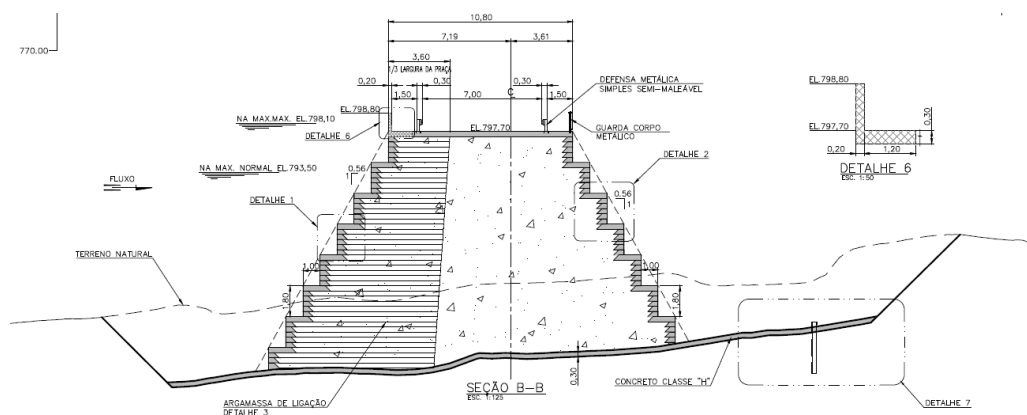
Seção típica transversal do maciço de CCR da estrutura de contenção jusante
